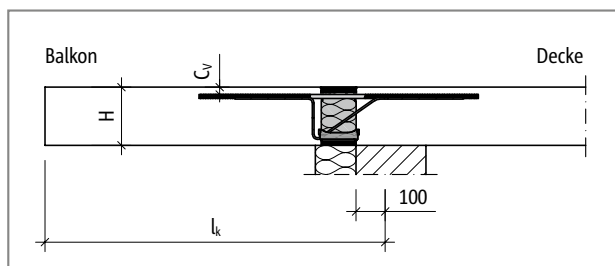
Schöck Isokorb® CXT Typ K: Statisches System
